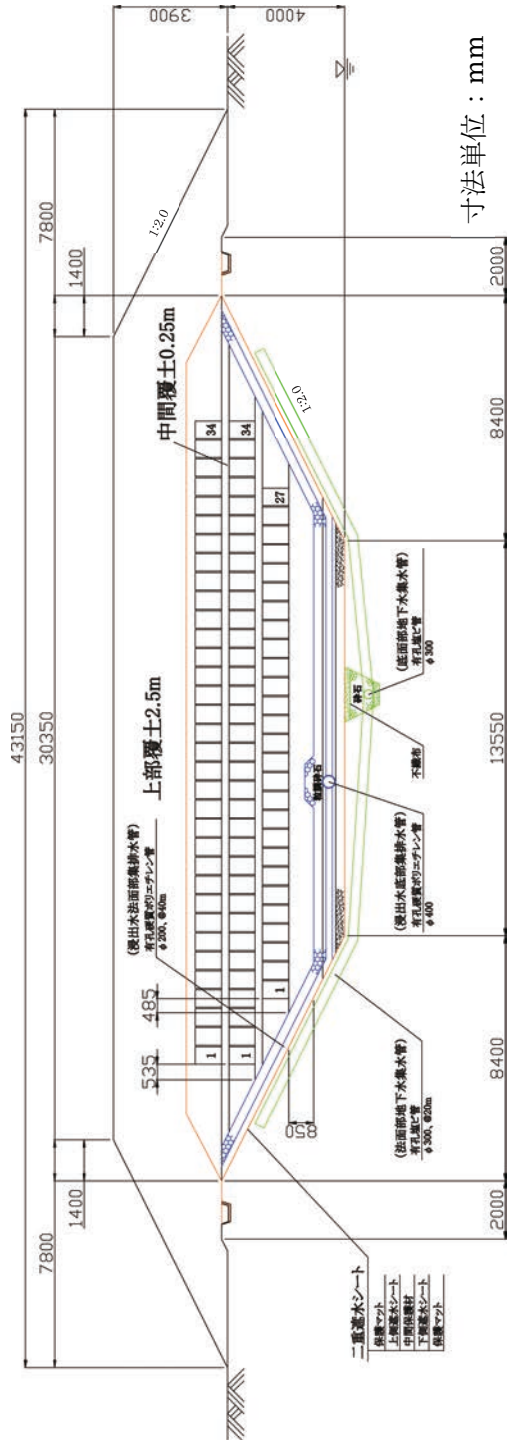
安定型トレンチの底部平面図、縦断面図 (S埋設地)
